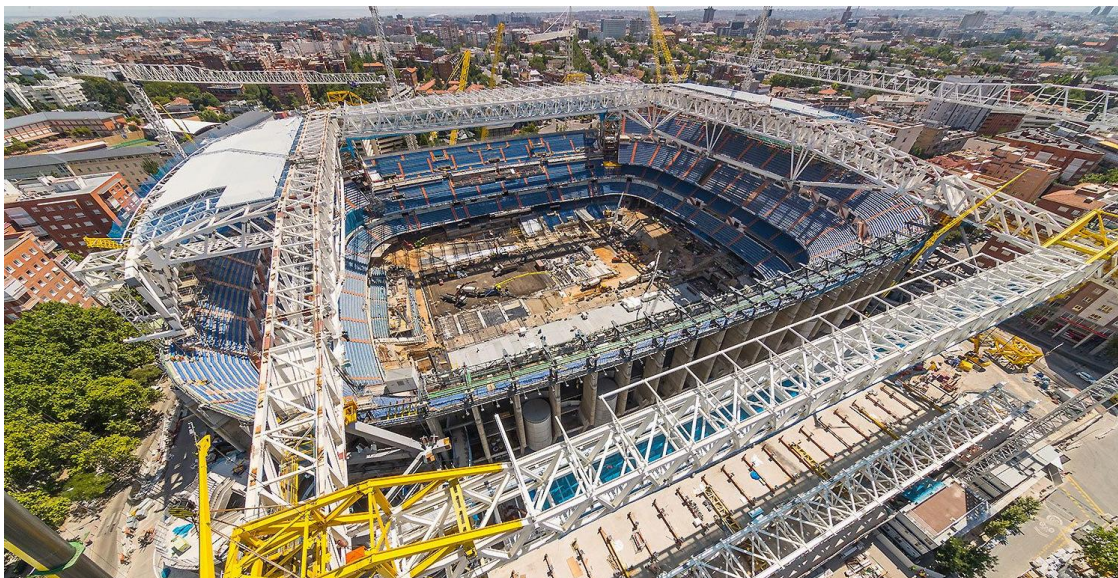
Montaje por izado (heavy lifting) de celosías de la cubierta fija, ejecutado en pleno centro de Madrid sin interrumpir el uso del estadio.
